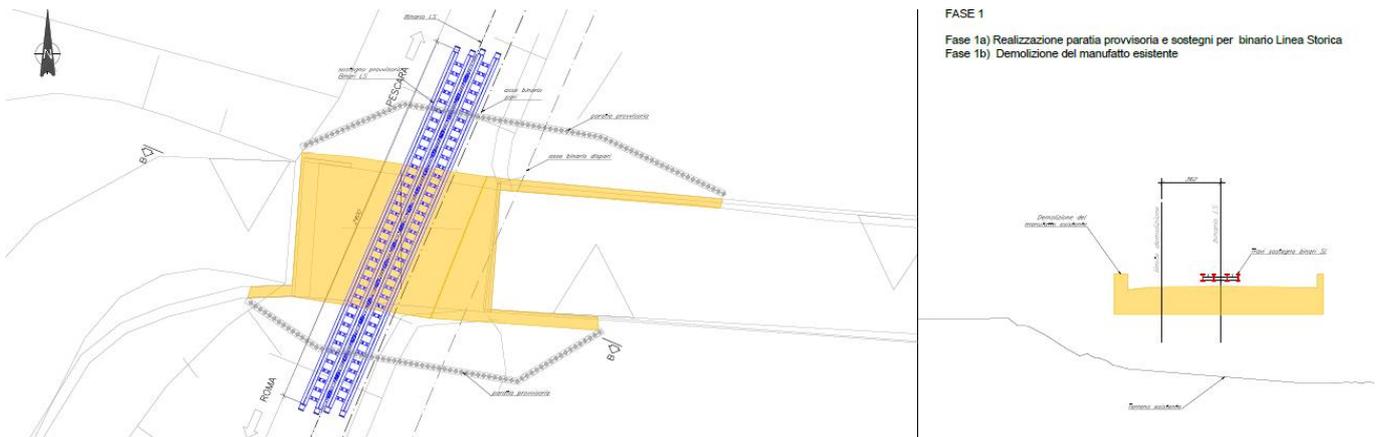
SL26 – Fase realizzativa 1, pianta e sezione sottopasso
